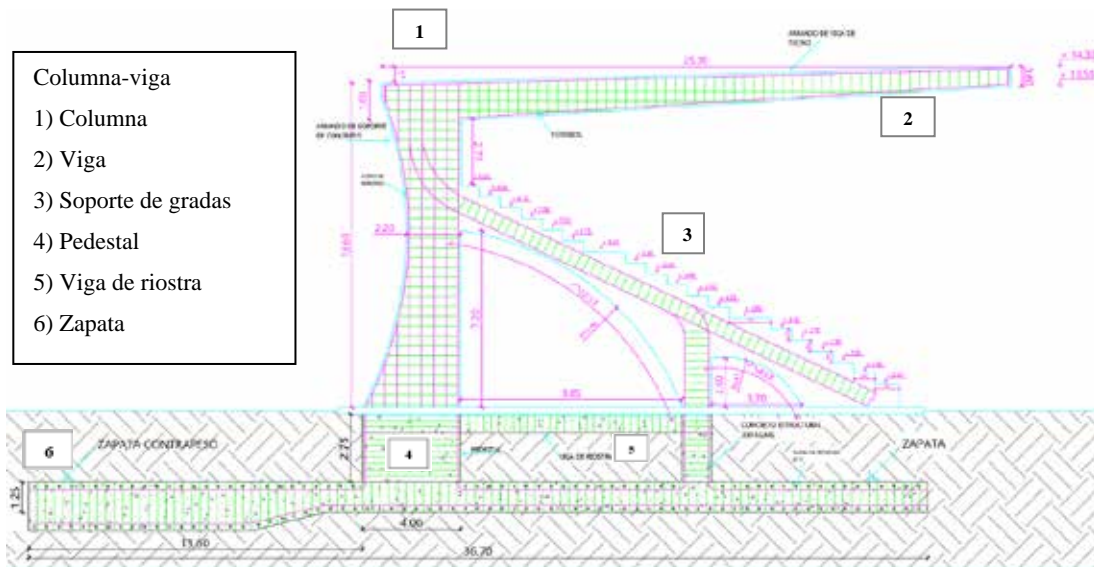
Detalle estructural de columna-viga del salón ferial. La Autora (2020)
